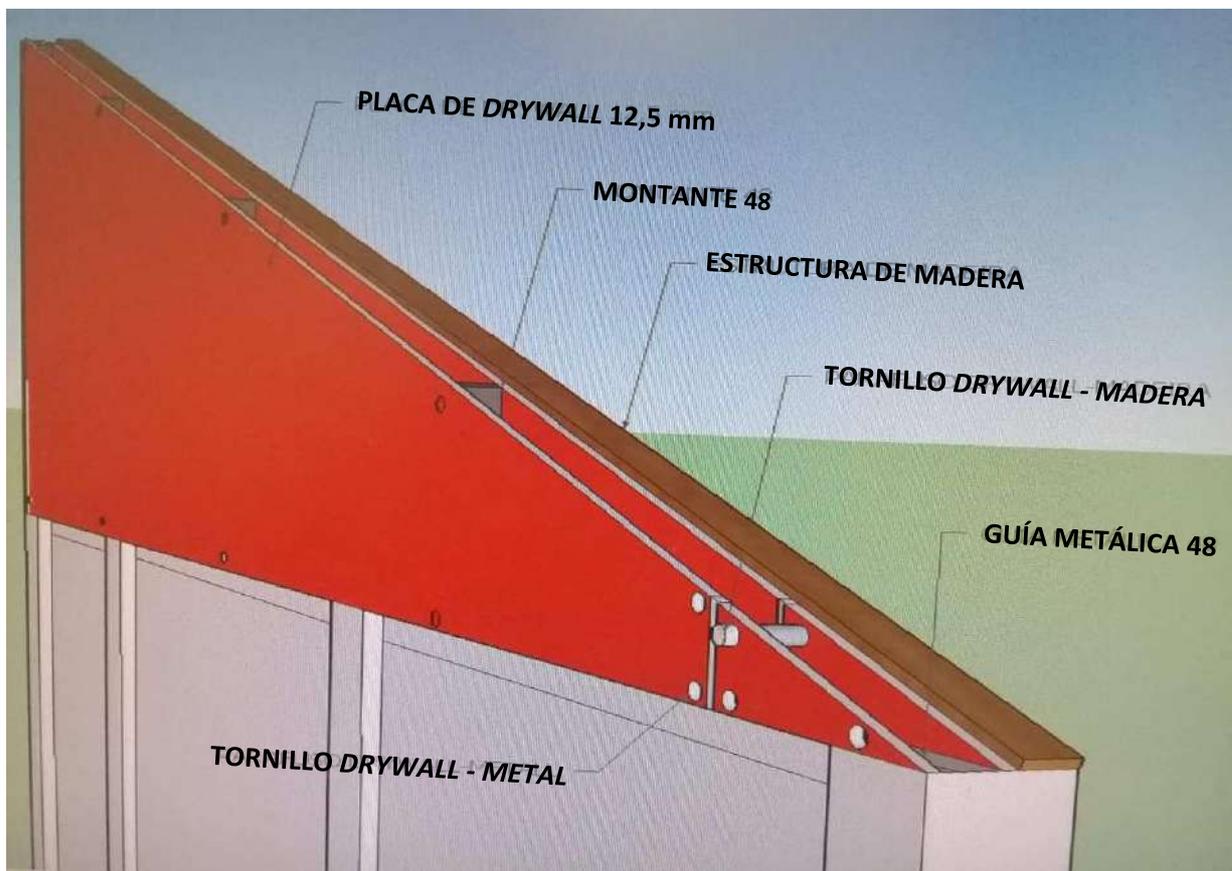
Detalle – Fijación del muro vertical en la cercha (cara de la pared orientada hacia el ambiente adyacente a la cocina).
